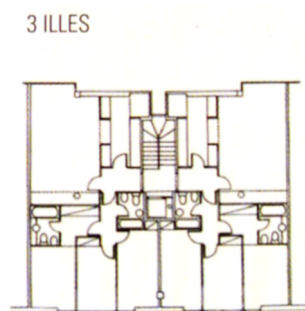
Plano del edificio - 2 viviendas por planta (fuente "Cerdà i la Barcelona del Futur")
